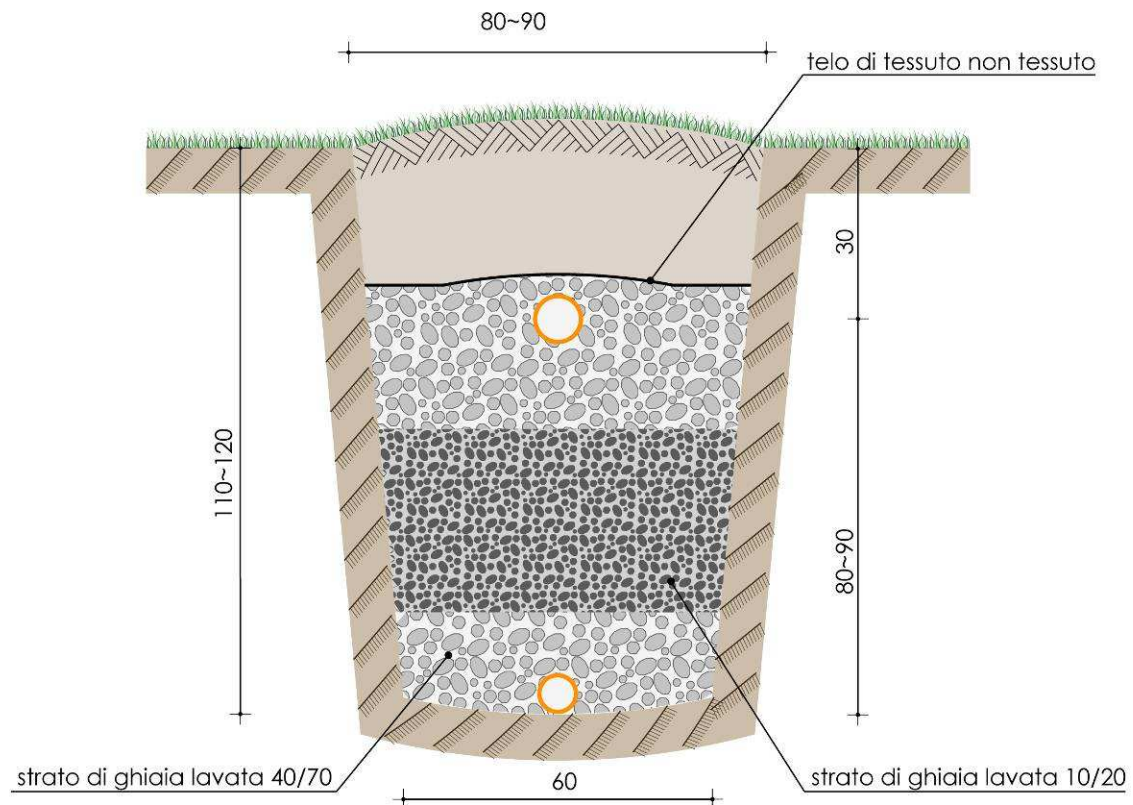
Sezione verticale trasversale di una trincea di un sistema di subdispersione con drenaggio.
